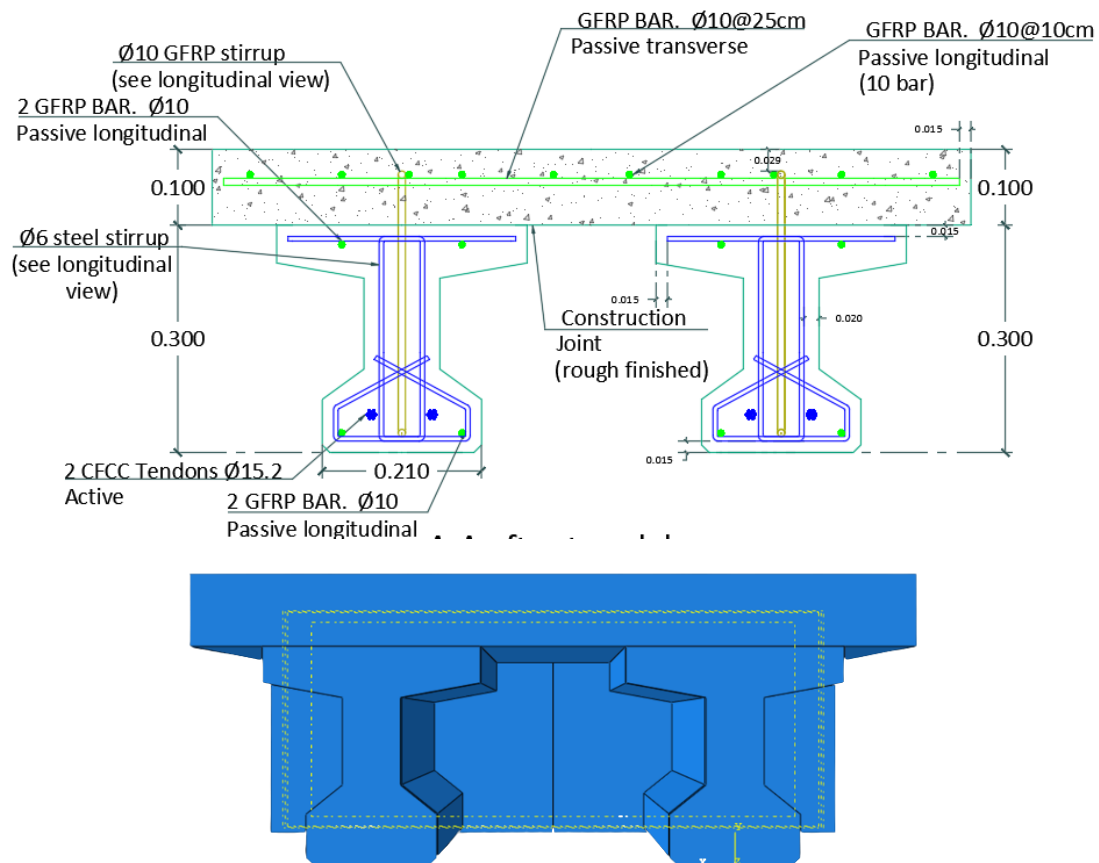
Geometría transversal de las vigas doble T y la losa propuesta
